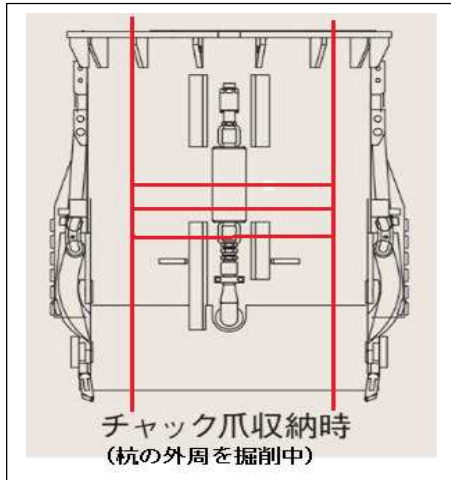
杭先端パワーチャッキング (PG) 工法 (同時注入方式) ・施工順序
